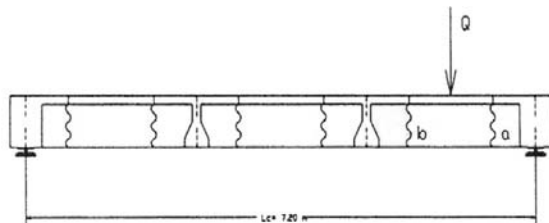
Ensayo de viga con sección cajón DC1 [ANLLÓ (1996)]
